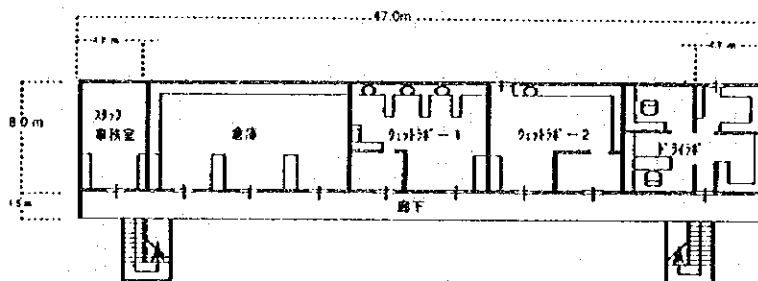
既存 MSP 管理研究棟 2 階平面図
